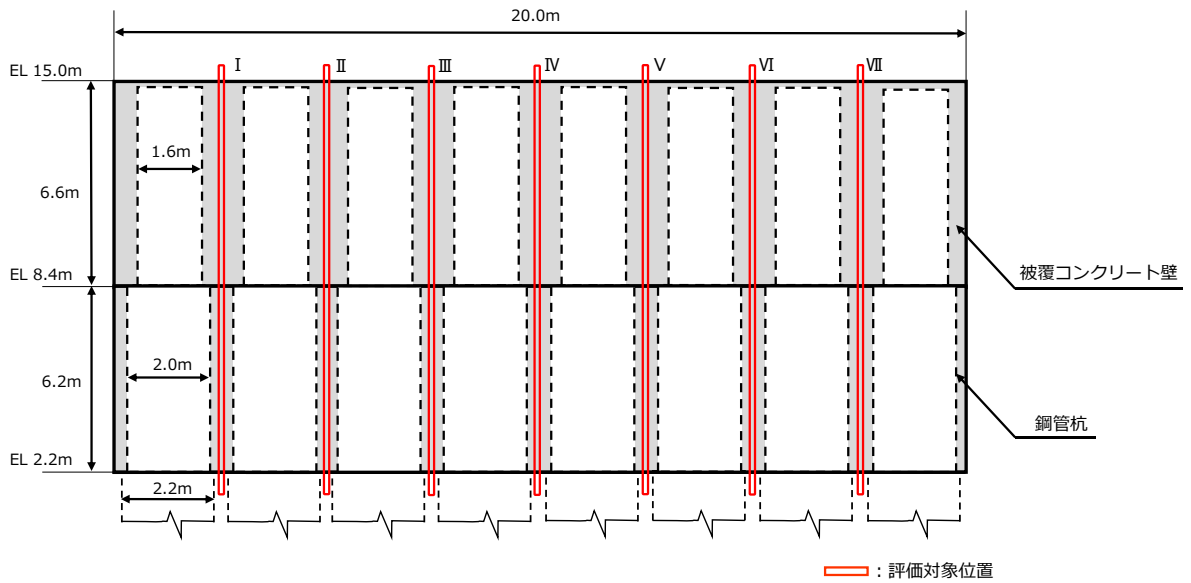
(5) 評価対象位置図 (③-③断面 正面図)
